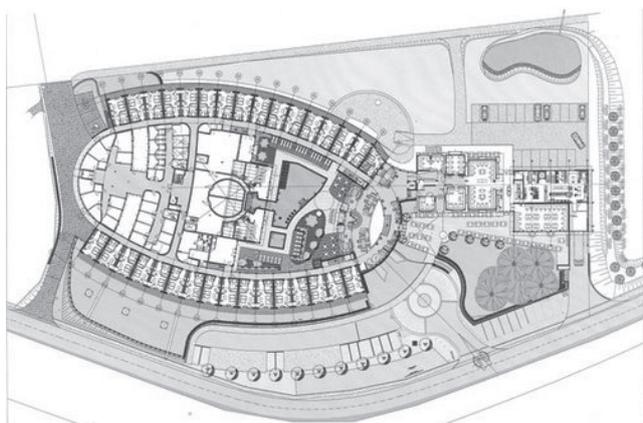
Grundriss Ebene 00 - Hotel „Die Wasnerin“
